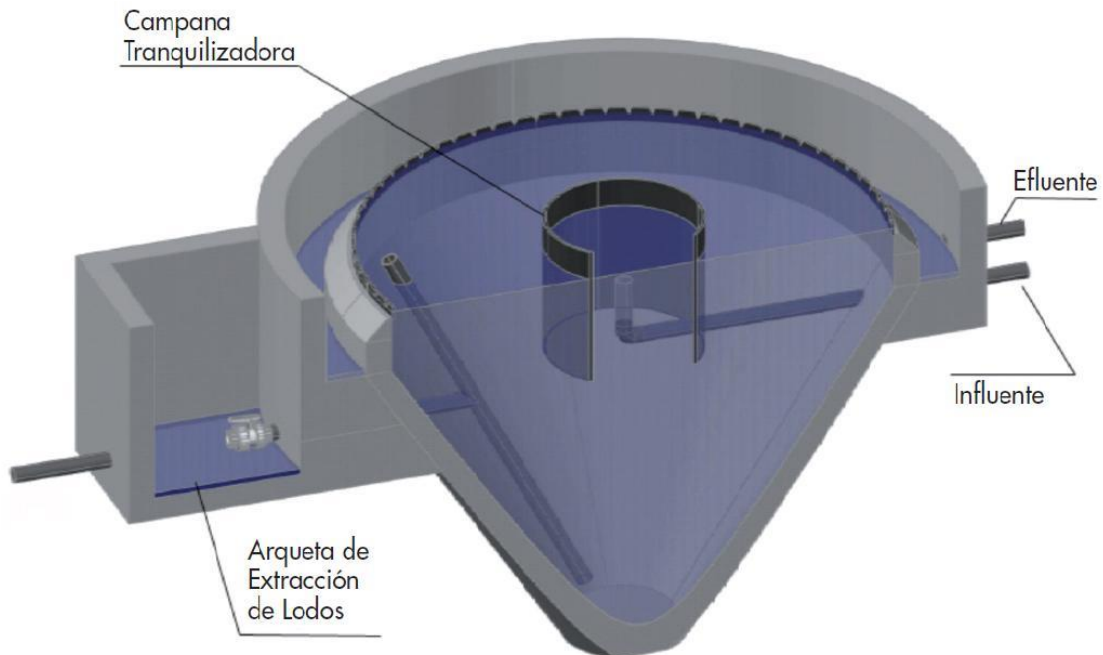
Esquema de un Decantador Primario cilindrocónico. Fuente: Ministerio de Fomento
